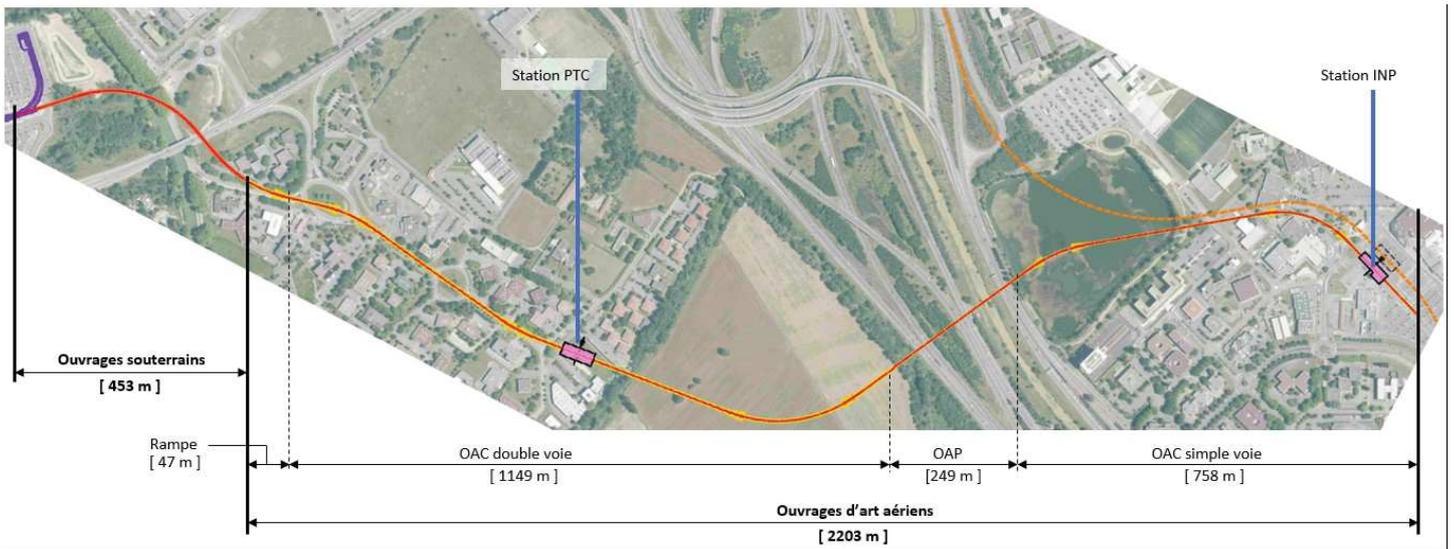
Vue en plan du tracé – (Source : Arcadis - Etudes AVP1)
